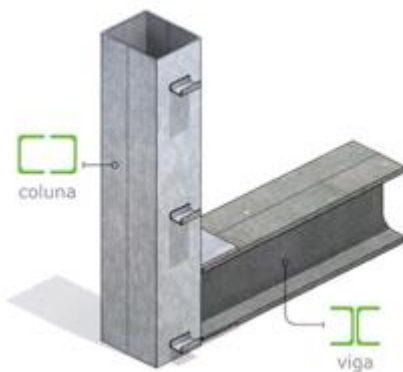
A construção em aço substitui vigas e colunas de concreto por estruturas feitas em aço.
